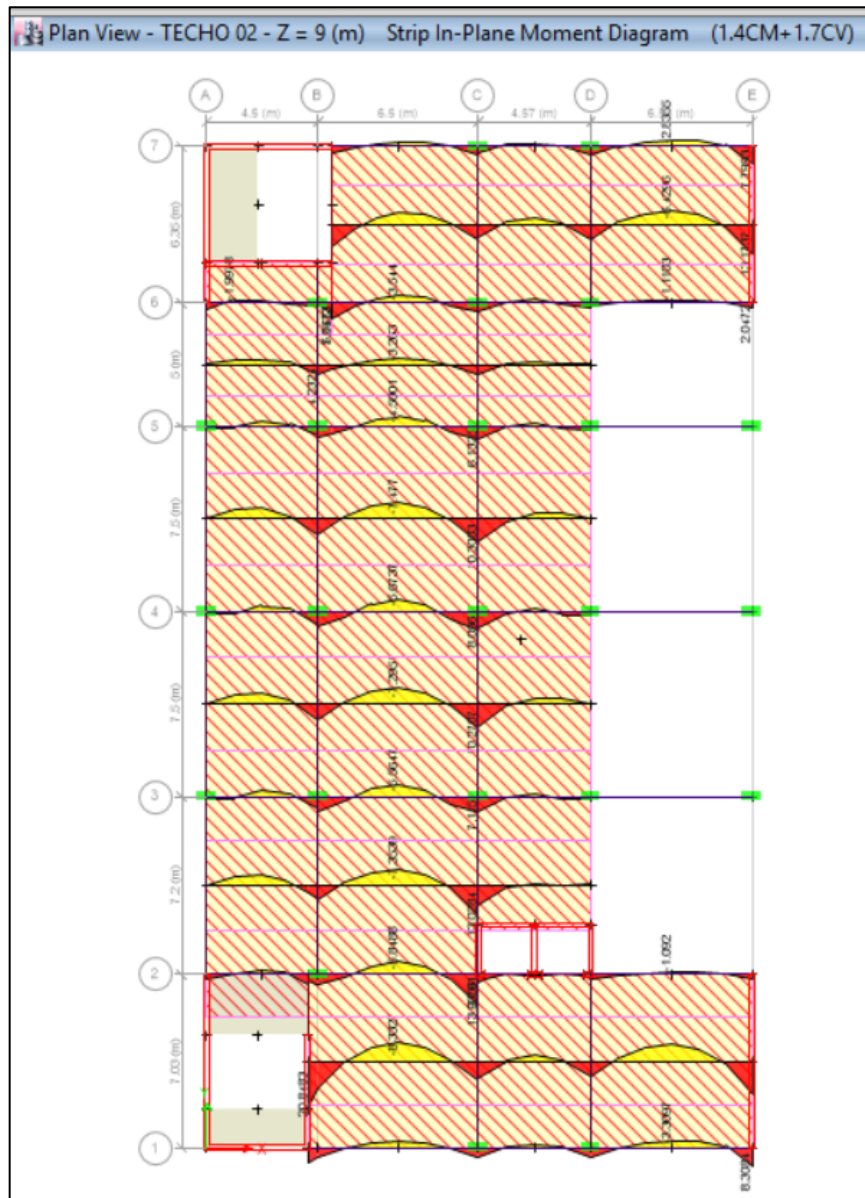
Planta del techo típico para el diseño de la losa maciza.
